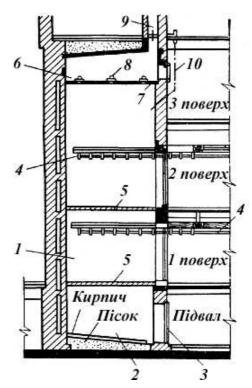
Обсмажувальна камера: 1 — вертикальна шахта; 2 — топка; 3 — дверцята; 4 — рейки підвісних шляхів; 5 — решітки; 6 — димова камера; 7 — плита; 8 — заслінки; 9 — шибер димаря; 10 — трос
